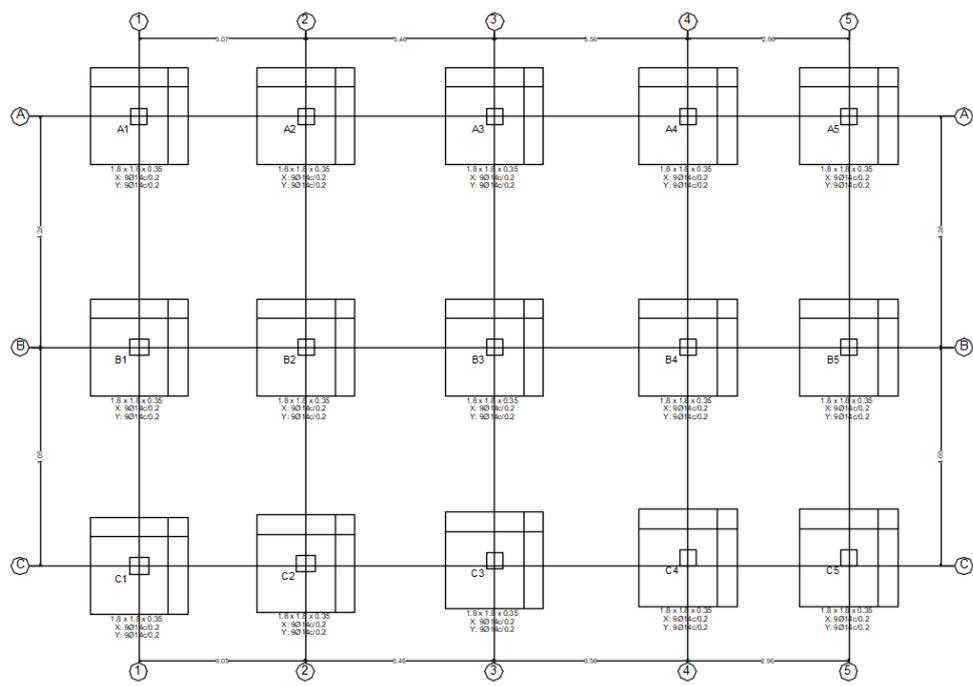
vista en planta de zapatas tipo de cimentación
